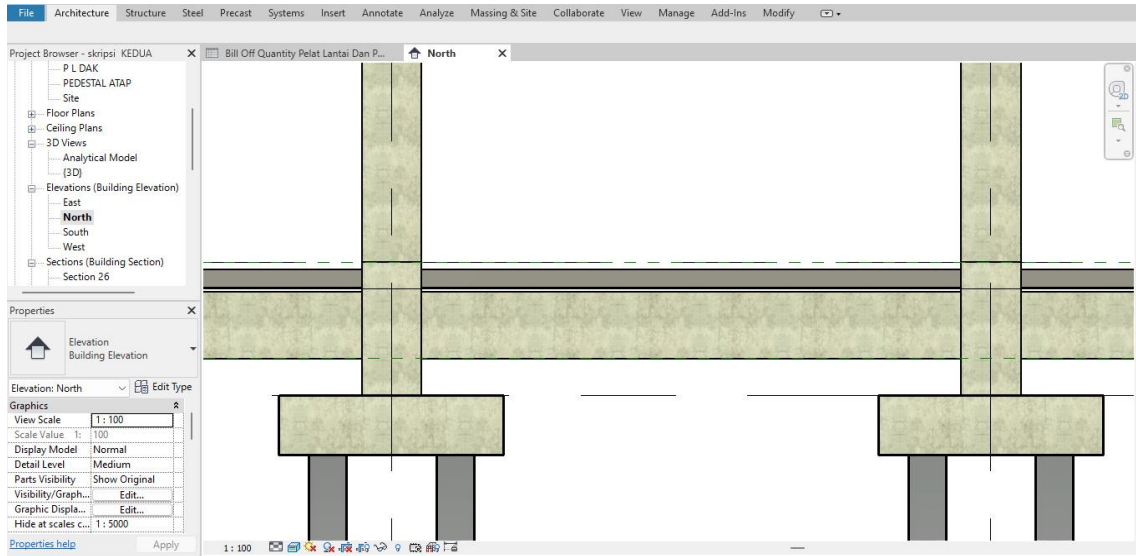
Tampilan Memasukkan Struktur Pondasi *Foot Plat* Kedalam Permodelan
